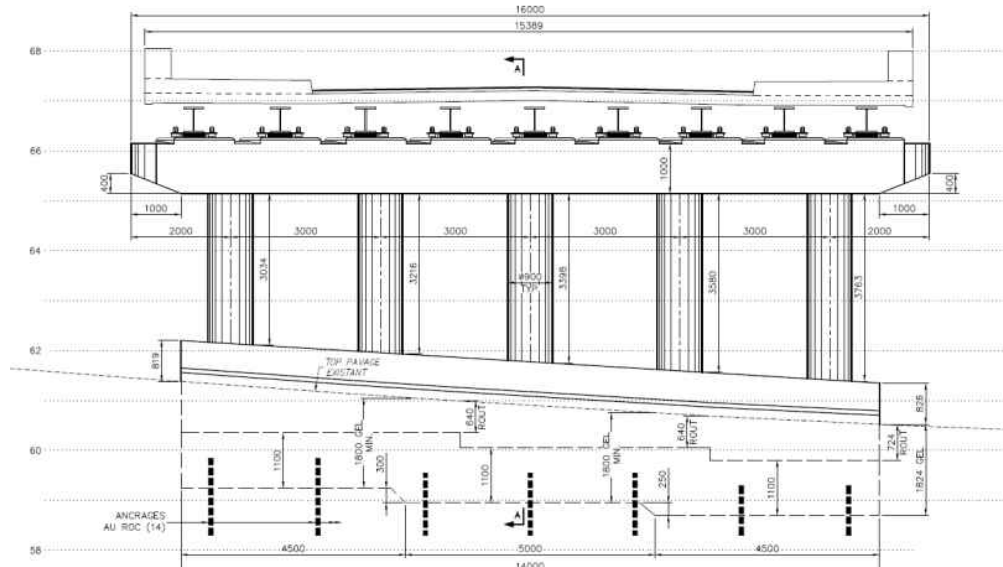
Pont d'étagement routier – Pile axe 2 – Variante B - Vue en élévation
